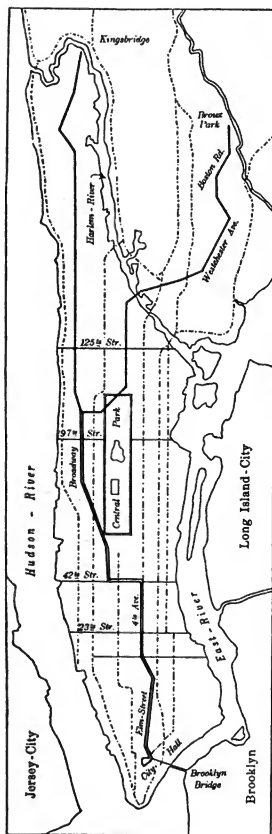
Lageplan der Untergrundbahnen in New-York.
